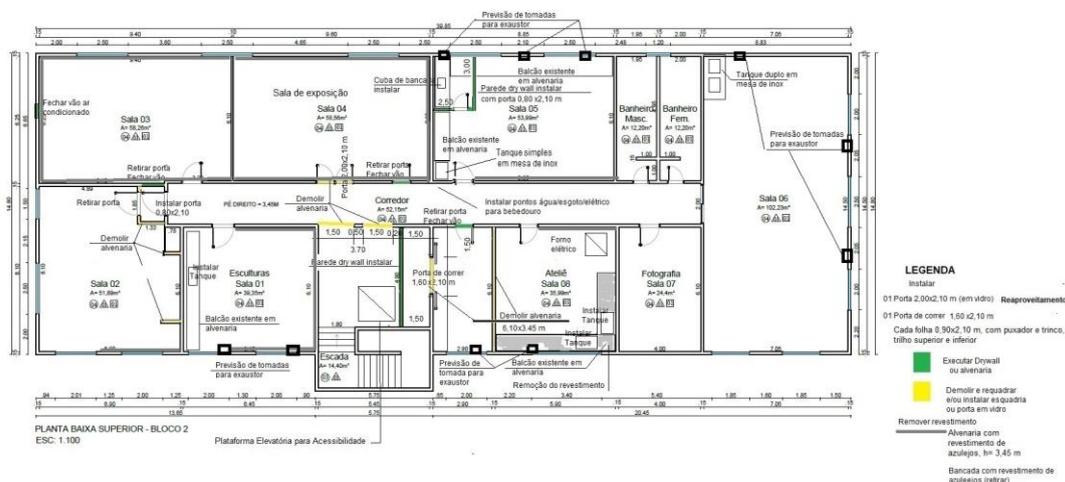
Layout Pavimento Superior BLOCO 2 – Campus Curitiba 2 - Sede Cabral
